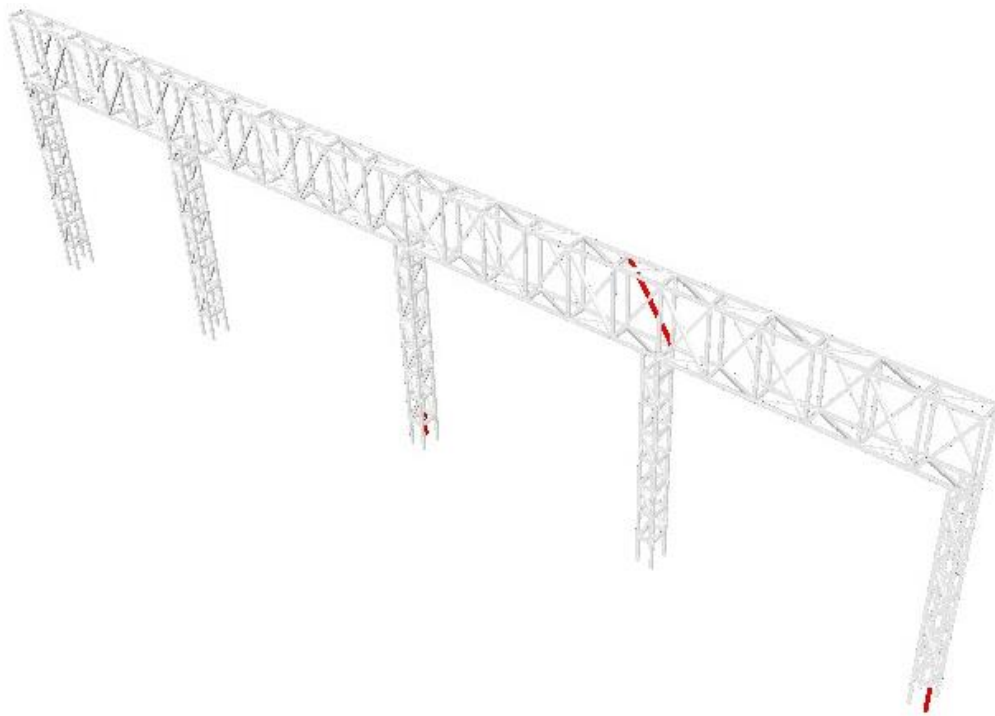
| *Barras consideradas del pórtico extremo
